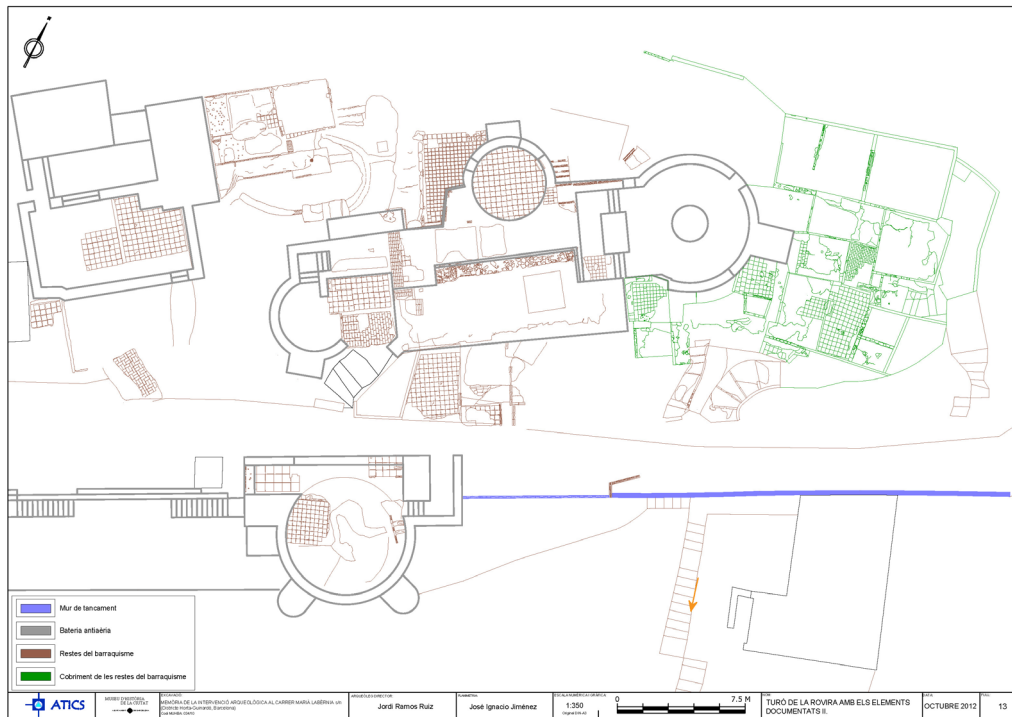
Planta detallada zona 2 de la excavació de la fase barraquista en el Turó de la Rovira.
